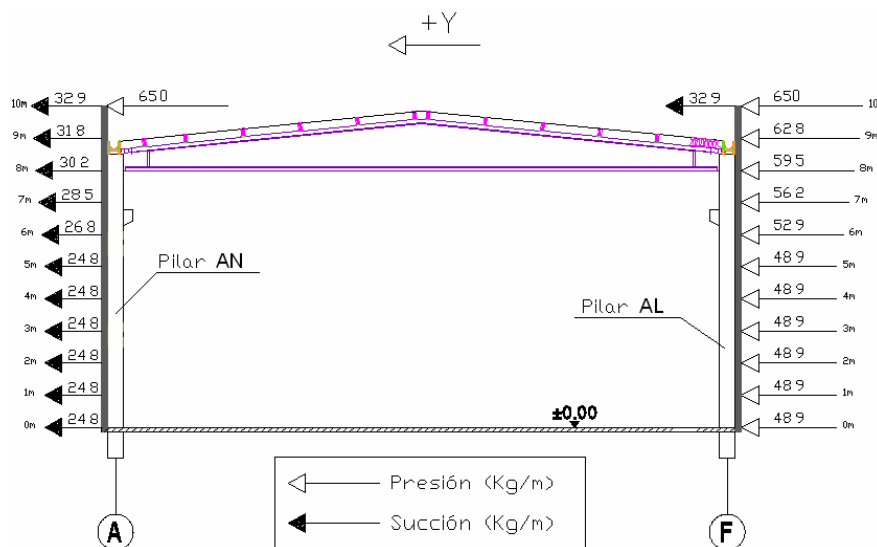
Detalle acción viento (+Y) en pilares F-5 y A-5
